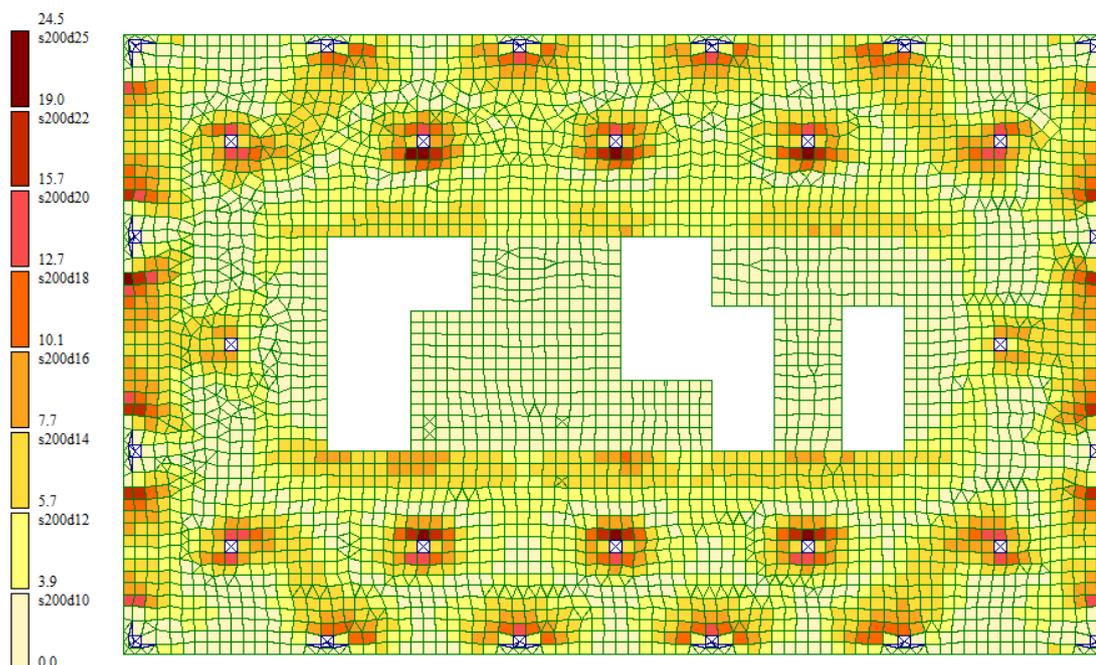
Схема армирования низа плит перекрытий по оси ОУ
